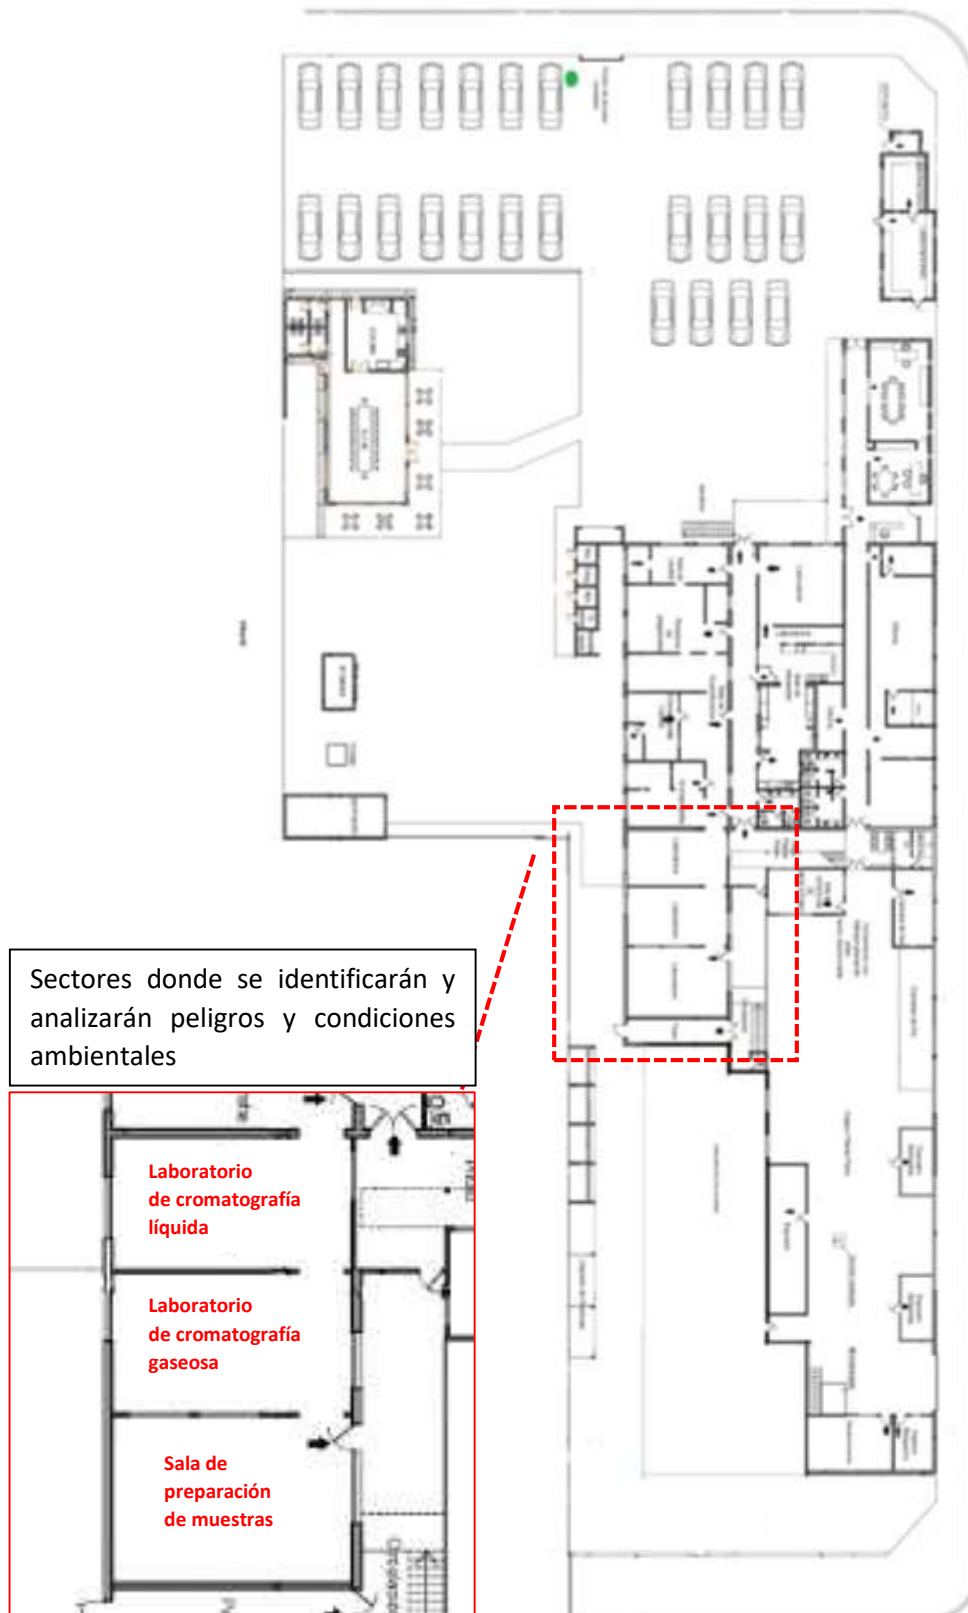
Plano sede Villa Regina planta baja – Sectorización sala preparación de muestras y laboratorios
